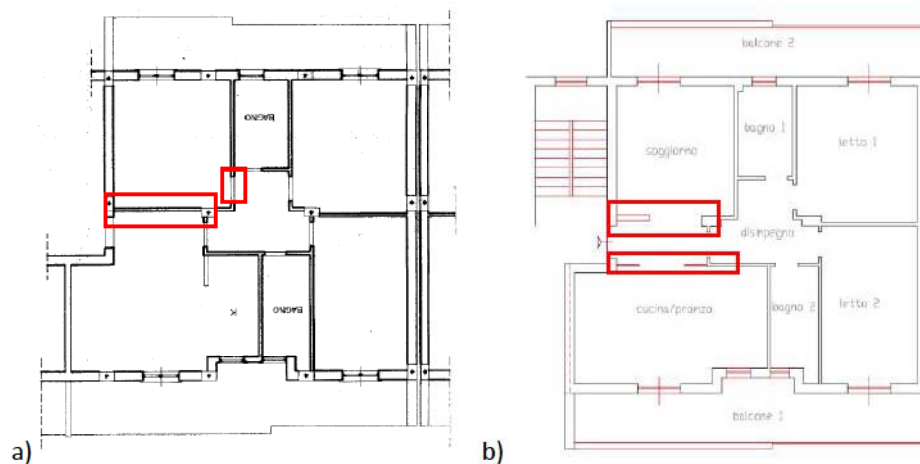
a) planimetria catastale dell'appartamento; b) planimetria dell'appartamento nello stato di fatto
